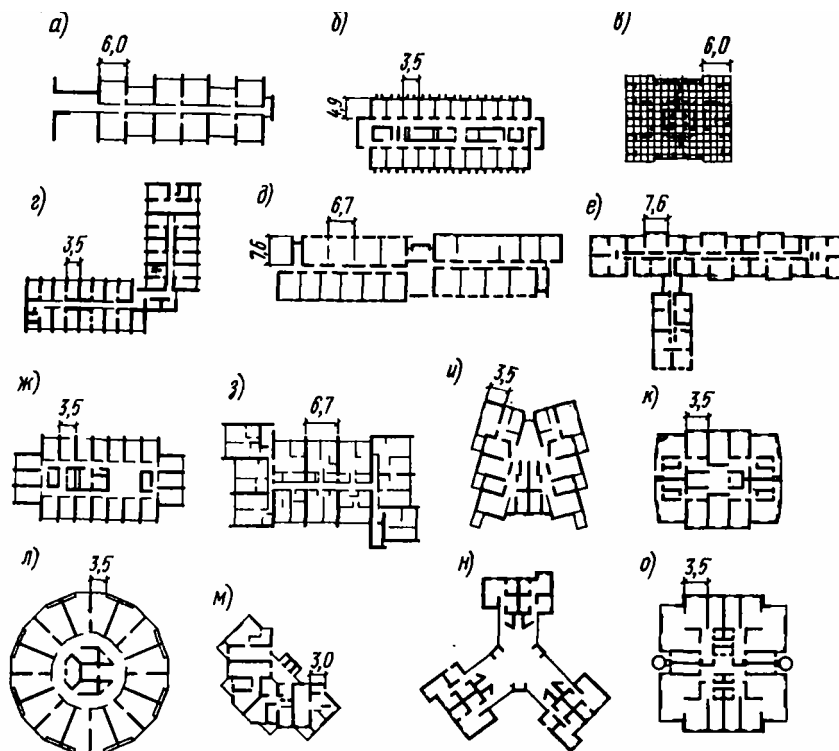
а. Система поперечных плоских стен, расположенных перпендикулярно длине здания, эта система не влияет на решение главного фасада;
